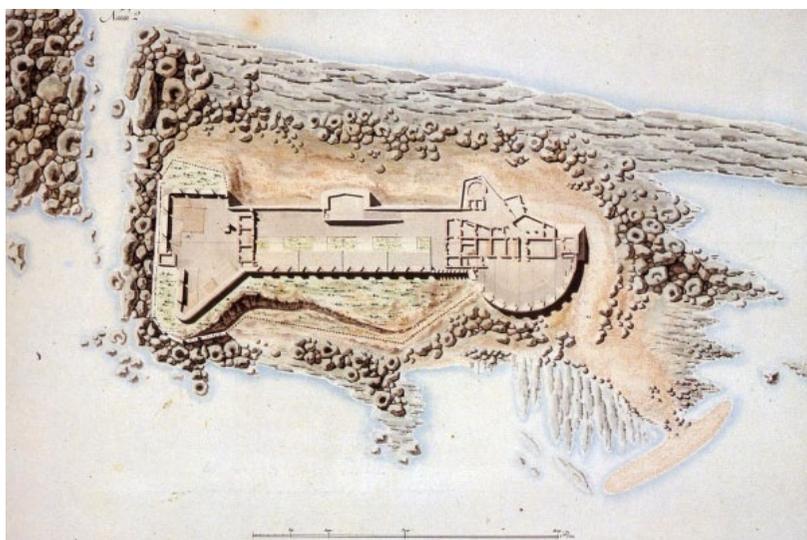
Plano de Sancti Petri hacia 1900. Fuente: Romero de Torres.
